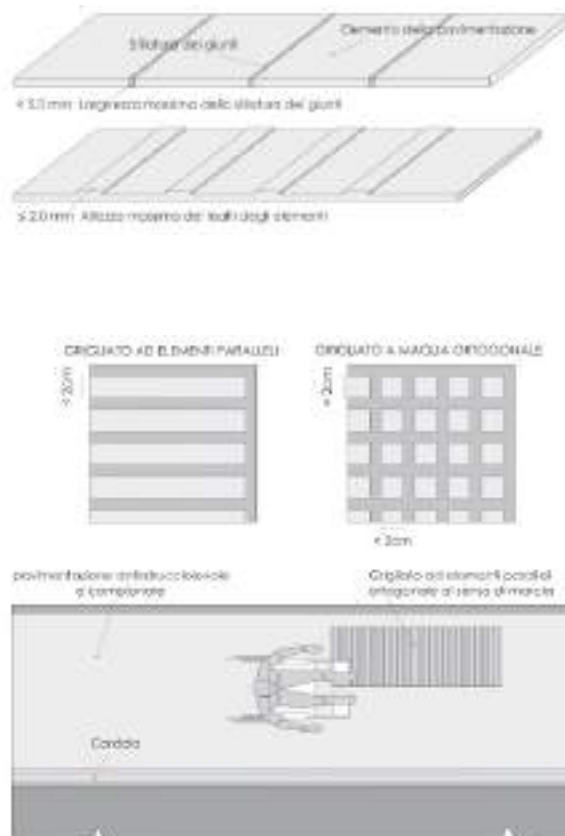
Specifiche funzionali e dimensionali di pavimentazione (fonte: Barriere architettoniche: guida a progetto di accessibilità e sicurezza dell'ambiente costruito)
